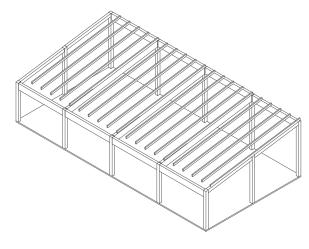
Axonometría estructural tipo 1_4 Fuente: Autores, 2024
